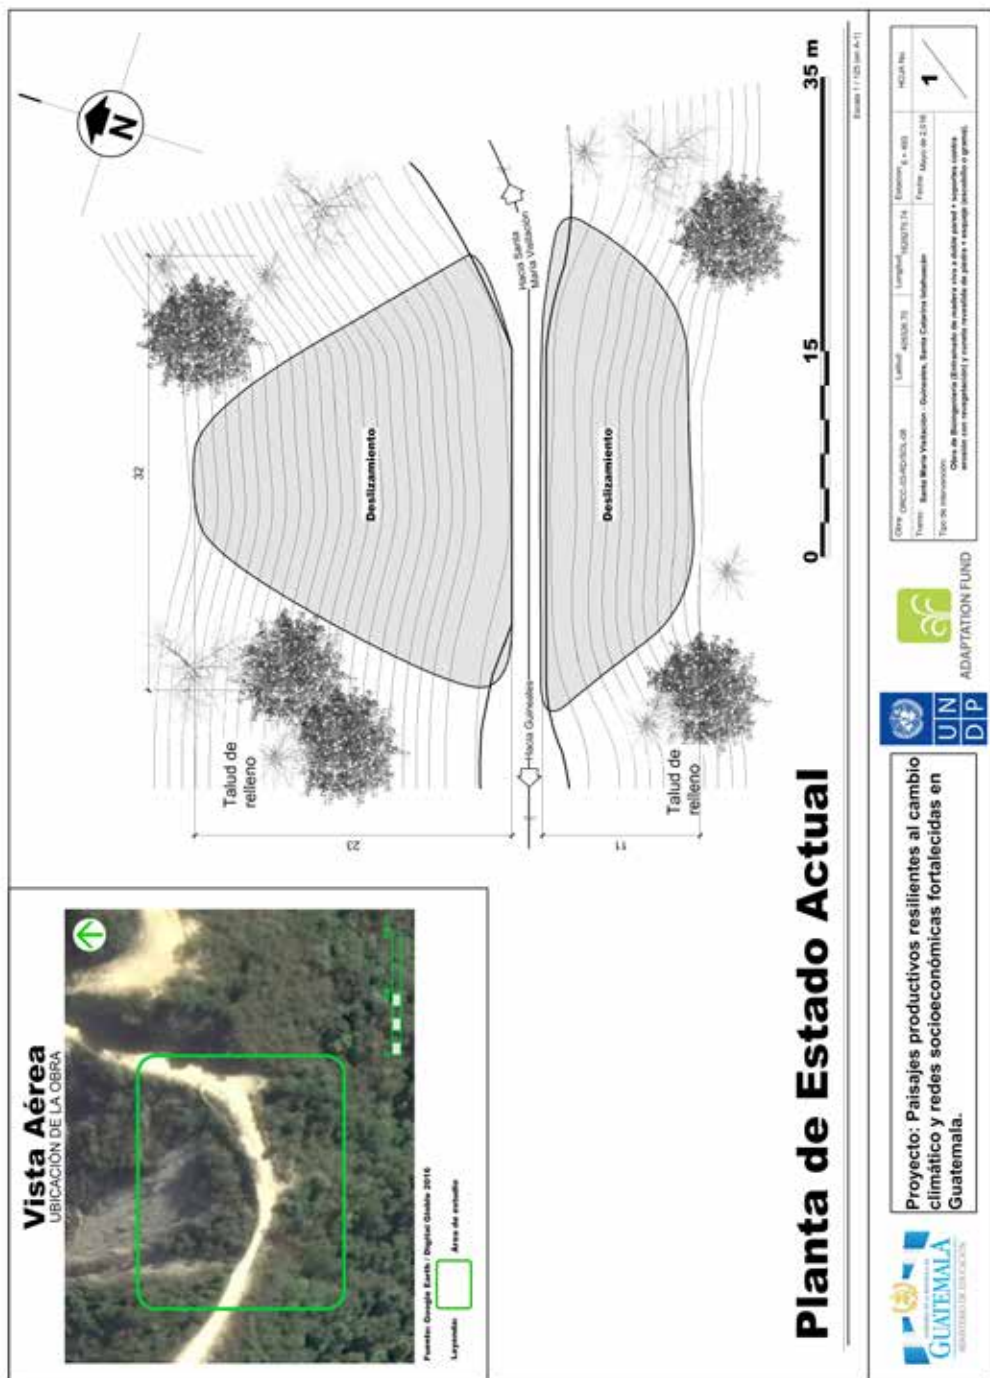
A. PLANTA ESTADO ACTUAL. Planificación Obra ORCC-03/RD-SOL-08. Tramo: (Santa María Visitación-Guineales, Sta. Catarina Ixtahuacán)
